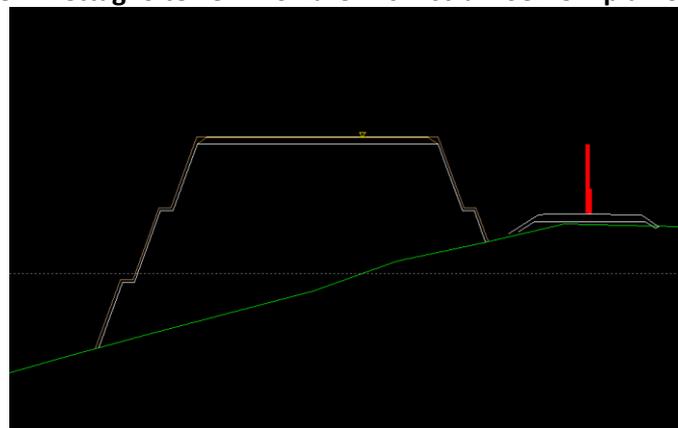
Dettaglio terre rinforzate – Sez. 4 – area montaggio gru
